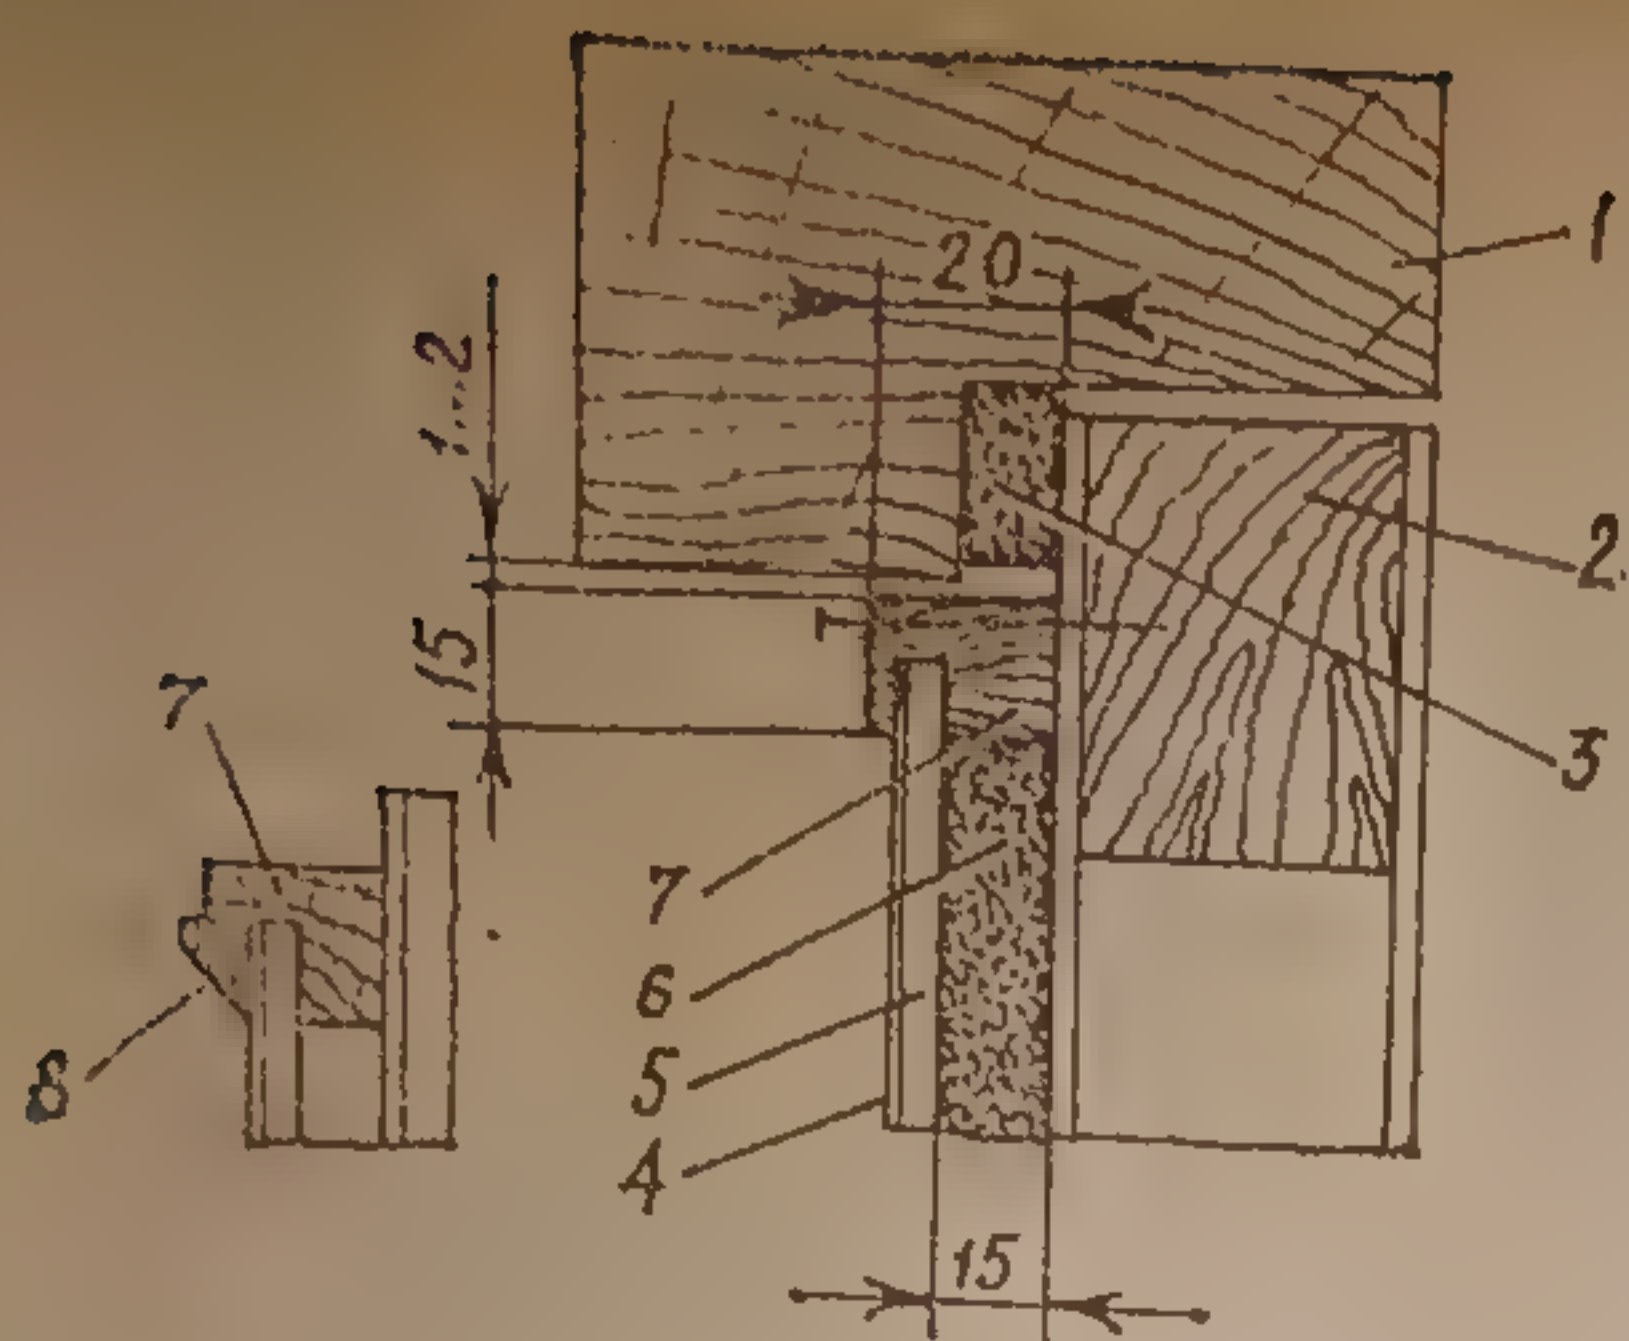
Обивка двери оргалитом: 1 — дверная коробка; 2 — входная дверь; 3 — уплотнитель; 4 — шпон; 5 — оргалит; 6 — утеплитель; 7 — рамка; 8 — шталик
